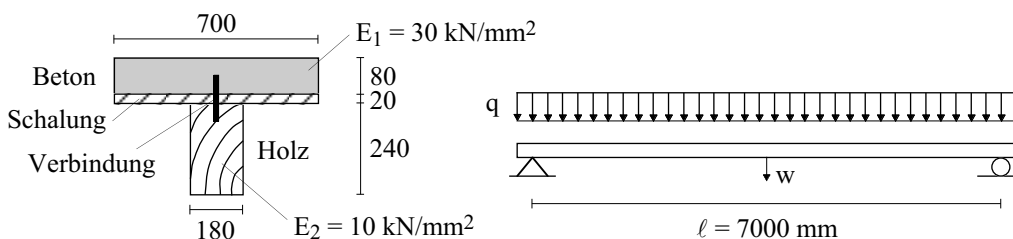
Beispiel einer Holz-Beton-Verbunddecke
